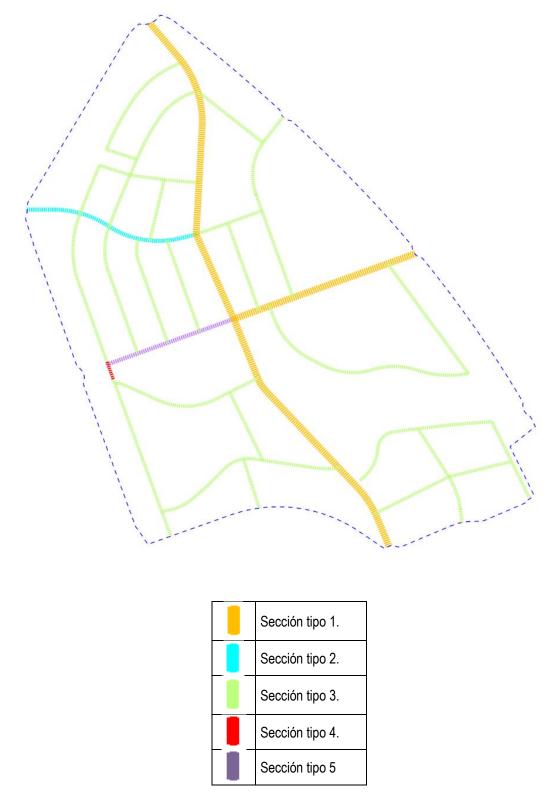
Distribución de las distintas secciones tipo dentro del sector
